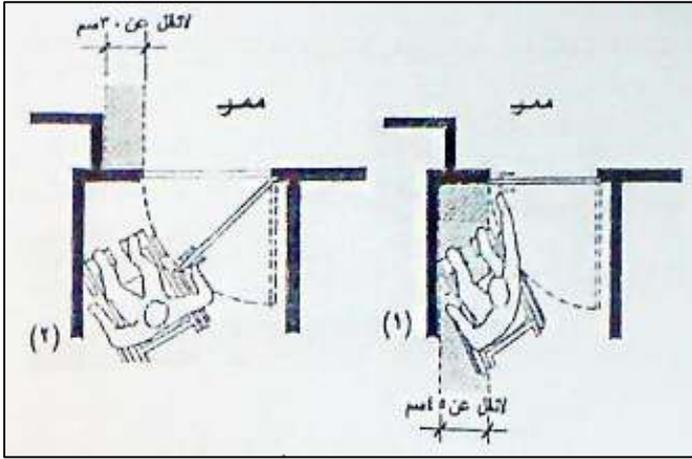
مسقط أفقي لنموذجين من غرف النزلاء بدار
